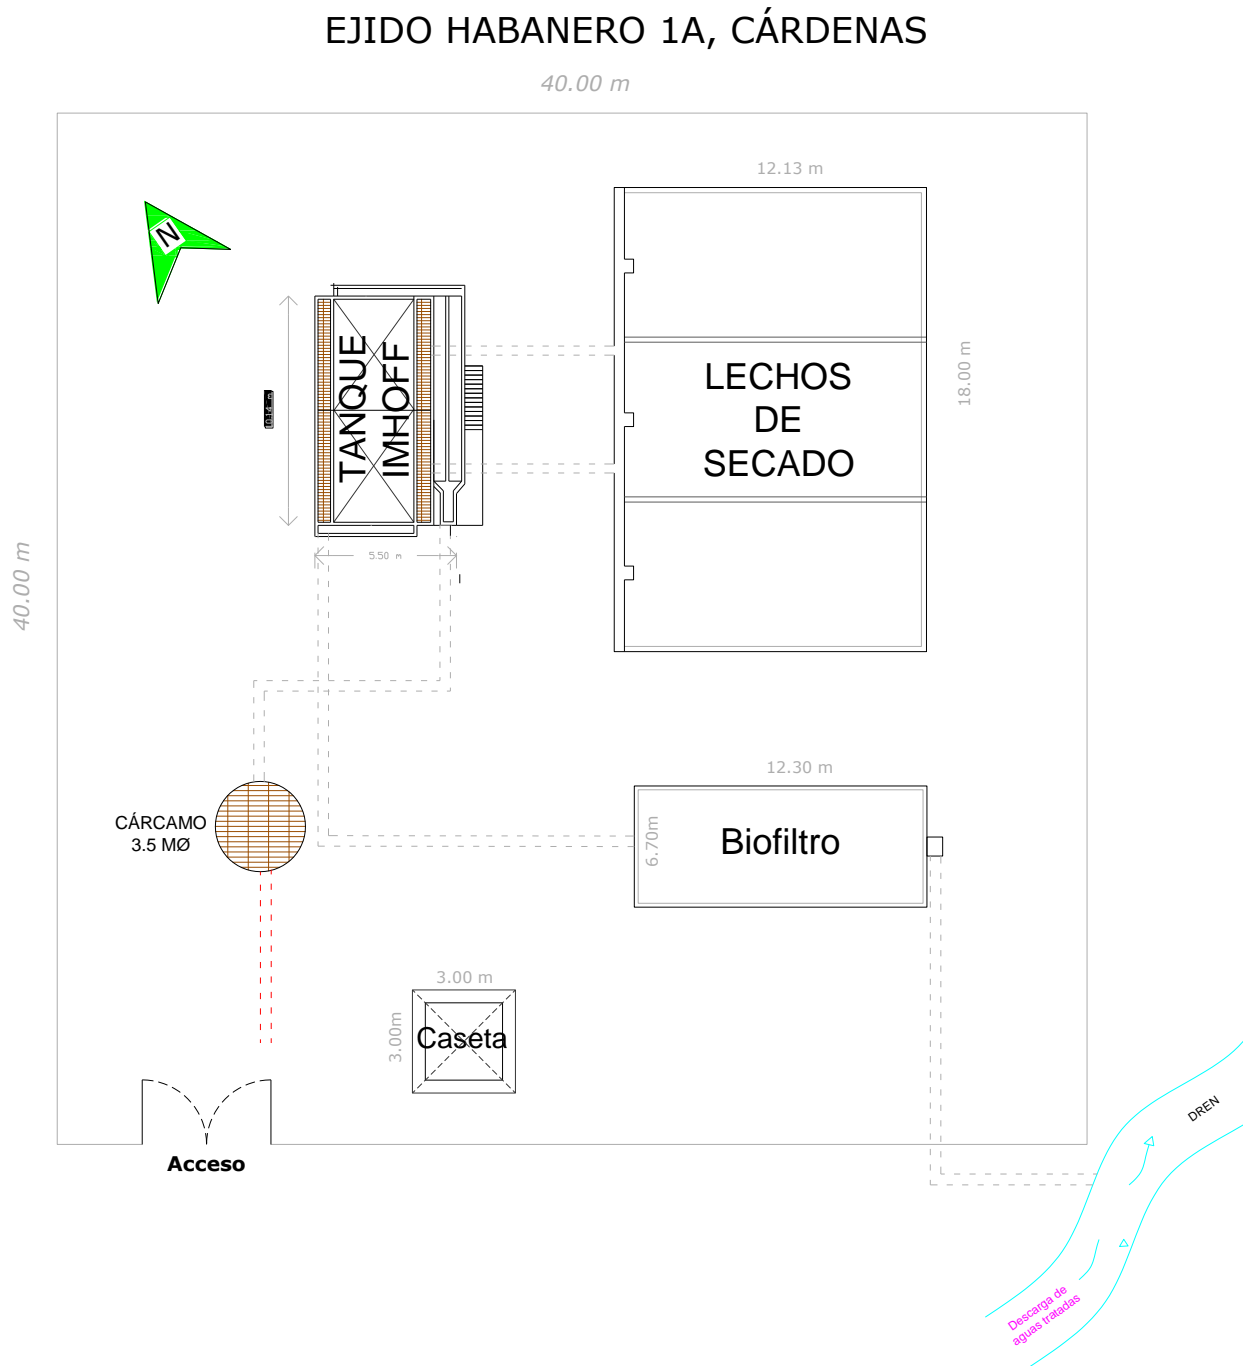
Imagen del plano general de la planta de tratamiento de aguas residuales Habanero.
